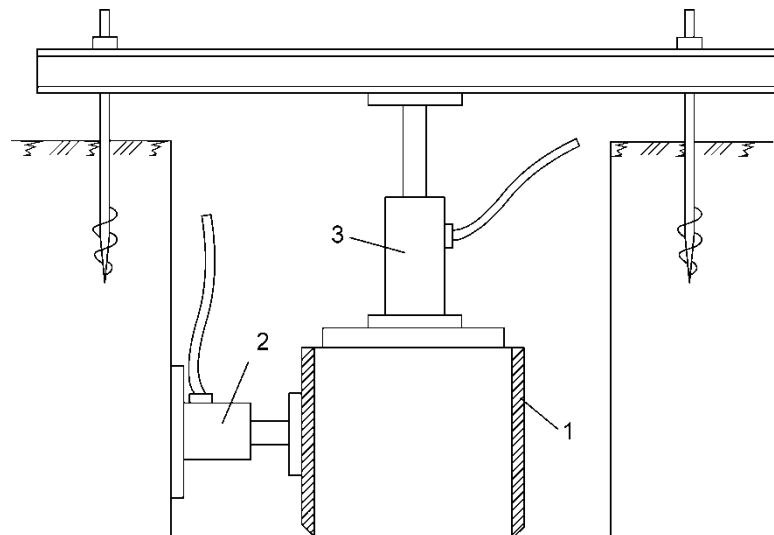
Испытания блока грунта на сдвиг: 1 – стальной цилиндр; 2 – домкрат горизонтальной нагрузки; 3 – домкрат вертикальной нагрузки
